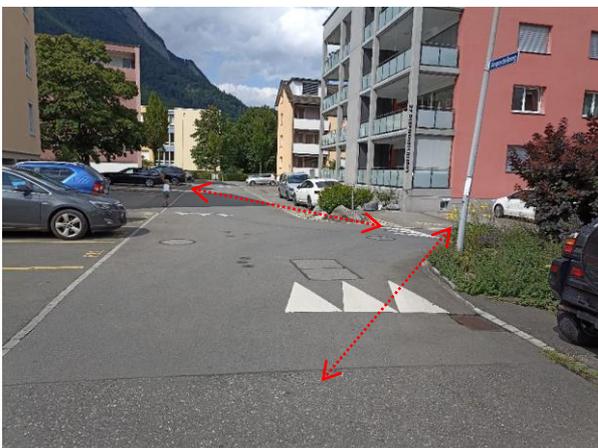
Gefahrenstelle Nr.3, Verzweigung Amperdellweg – Churfirstenstrasse mit eingeschränkter Sicht
